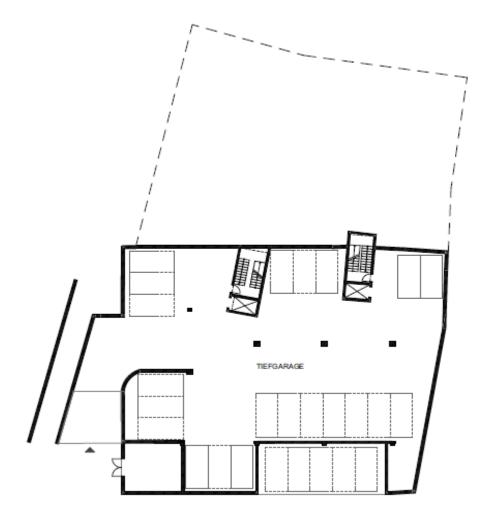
Grundriss 2. Untergeschoss (Mars-Architekten, 2020)
